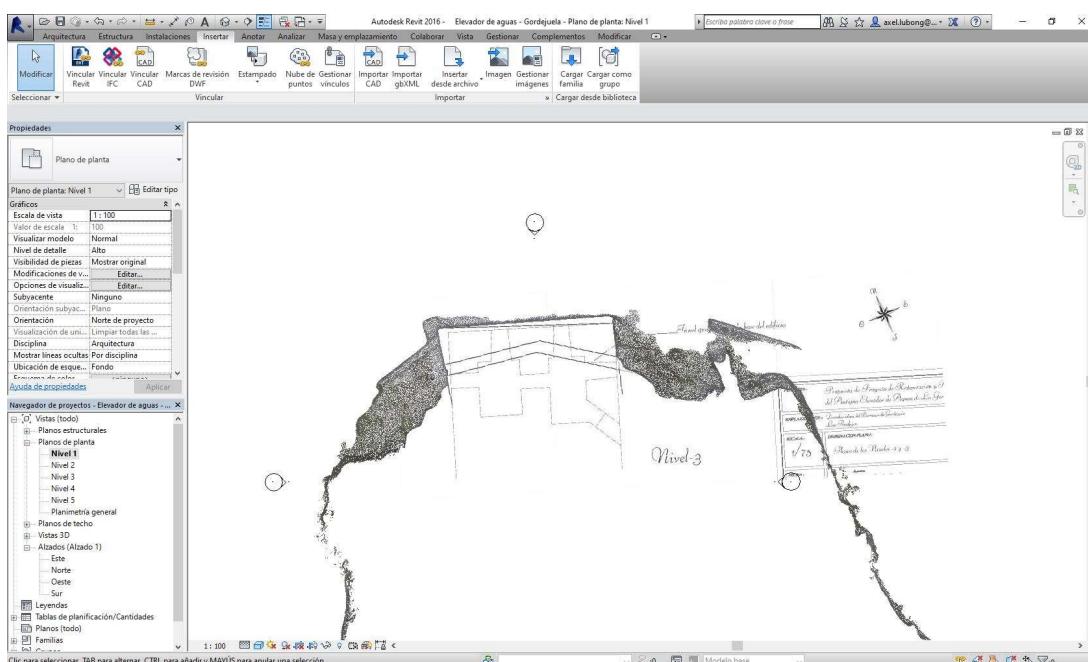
Vista en planta Nivel -3 con nube de puntos e imagen de plano. Fuente: Elaboración propia
